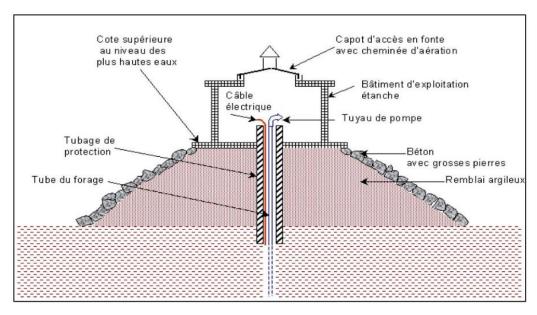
Exemple de protection d'une tête de forage en zone inondable, cas de figure où le niveau des plus hautes eaux est connu (source : BRGM).
